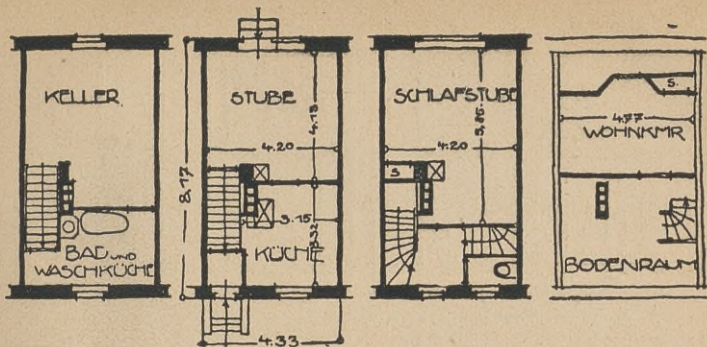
37. Haus von 4,30 m Front aus der Siedlung Spandau. Beb. Fläche 35,38 qm. Architekt Wolff
